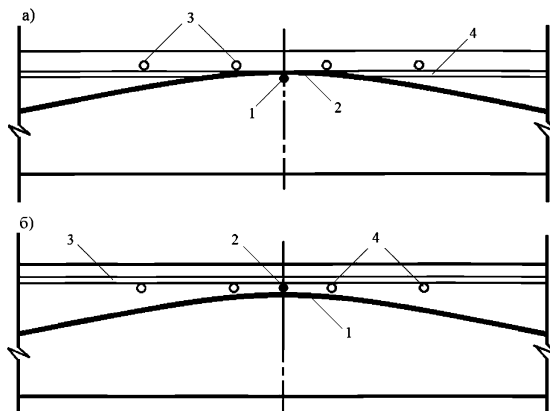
Взаимное расположение напрягаемых элементов и ненапрягаемой арматуры при армировании плит перекрытий в двух направлениях (а – в продольном направлении, б – в поперечном направлении):
